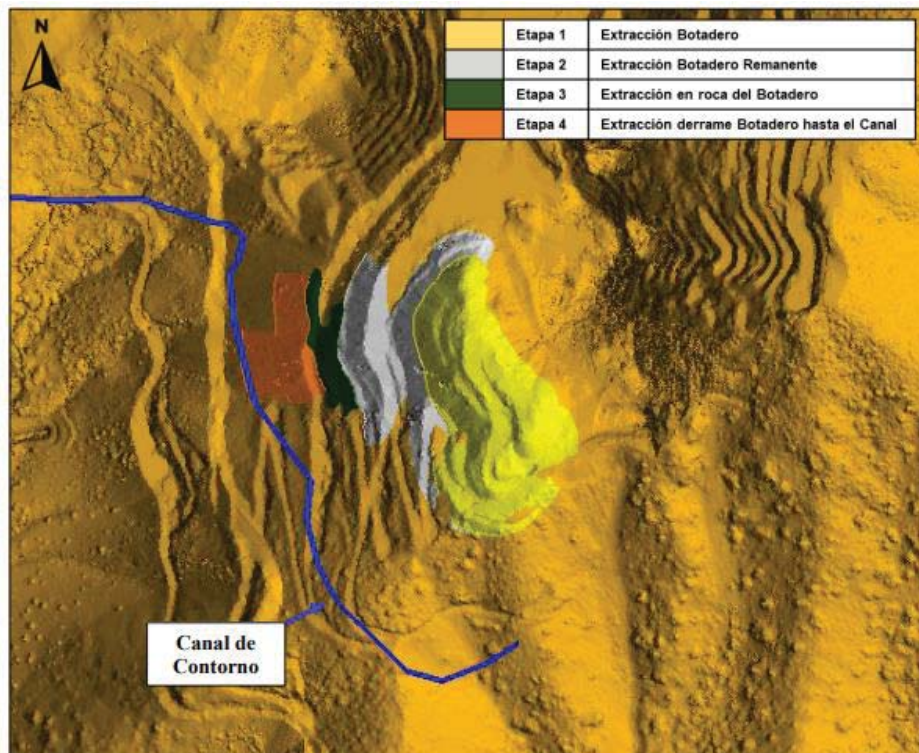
Vista en planta del material a remover en cada etapa de extracción
